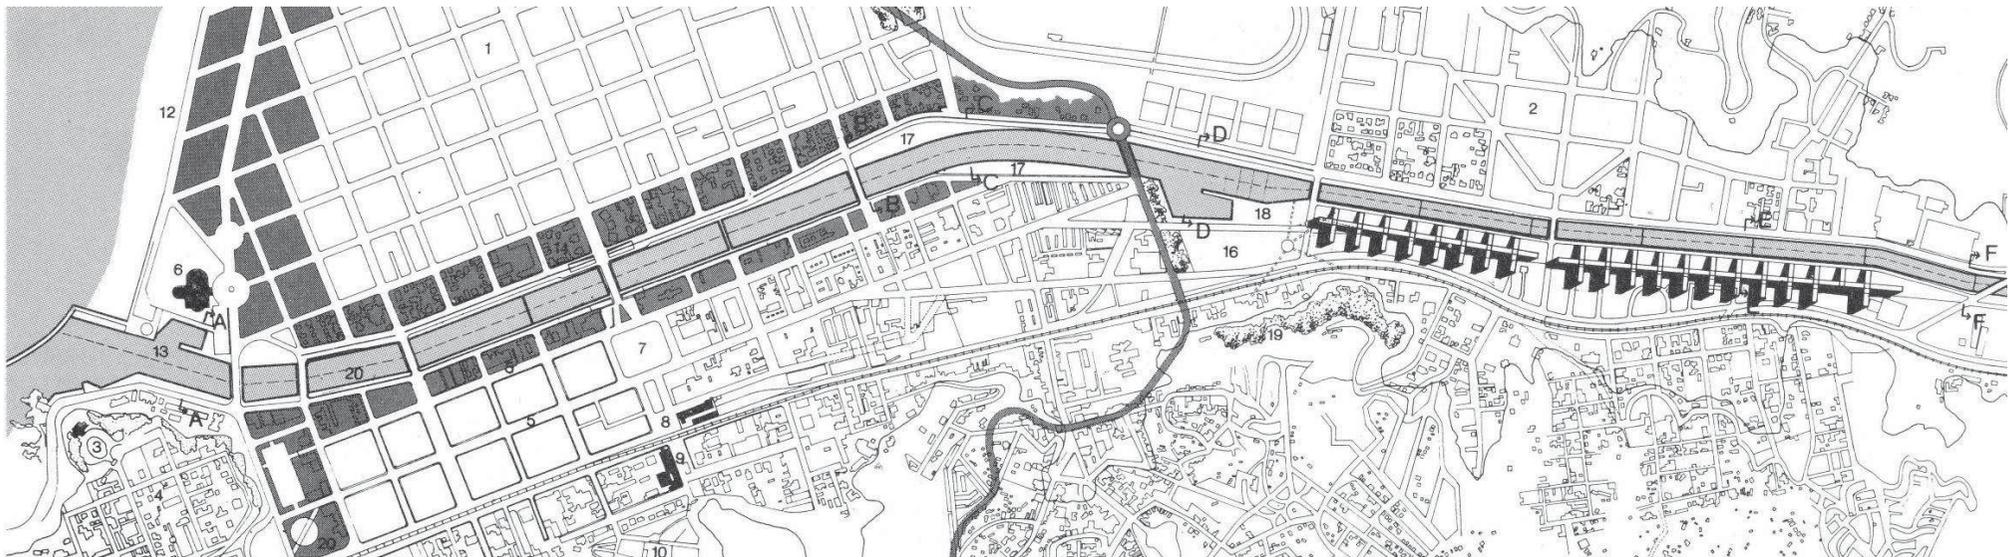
PLANTA PROYECTO UCV. 1970, Trazado total intervención.
